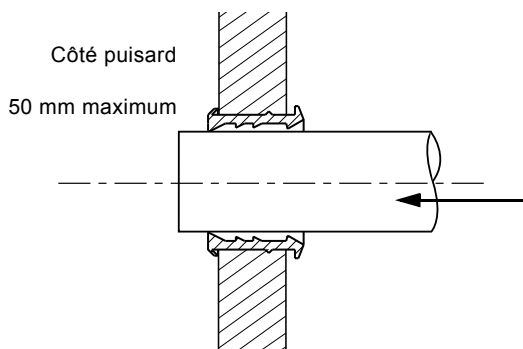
Tuyauterie avec manchon LM50/100, vue de côté
